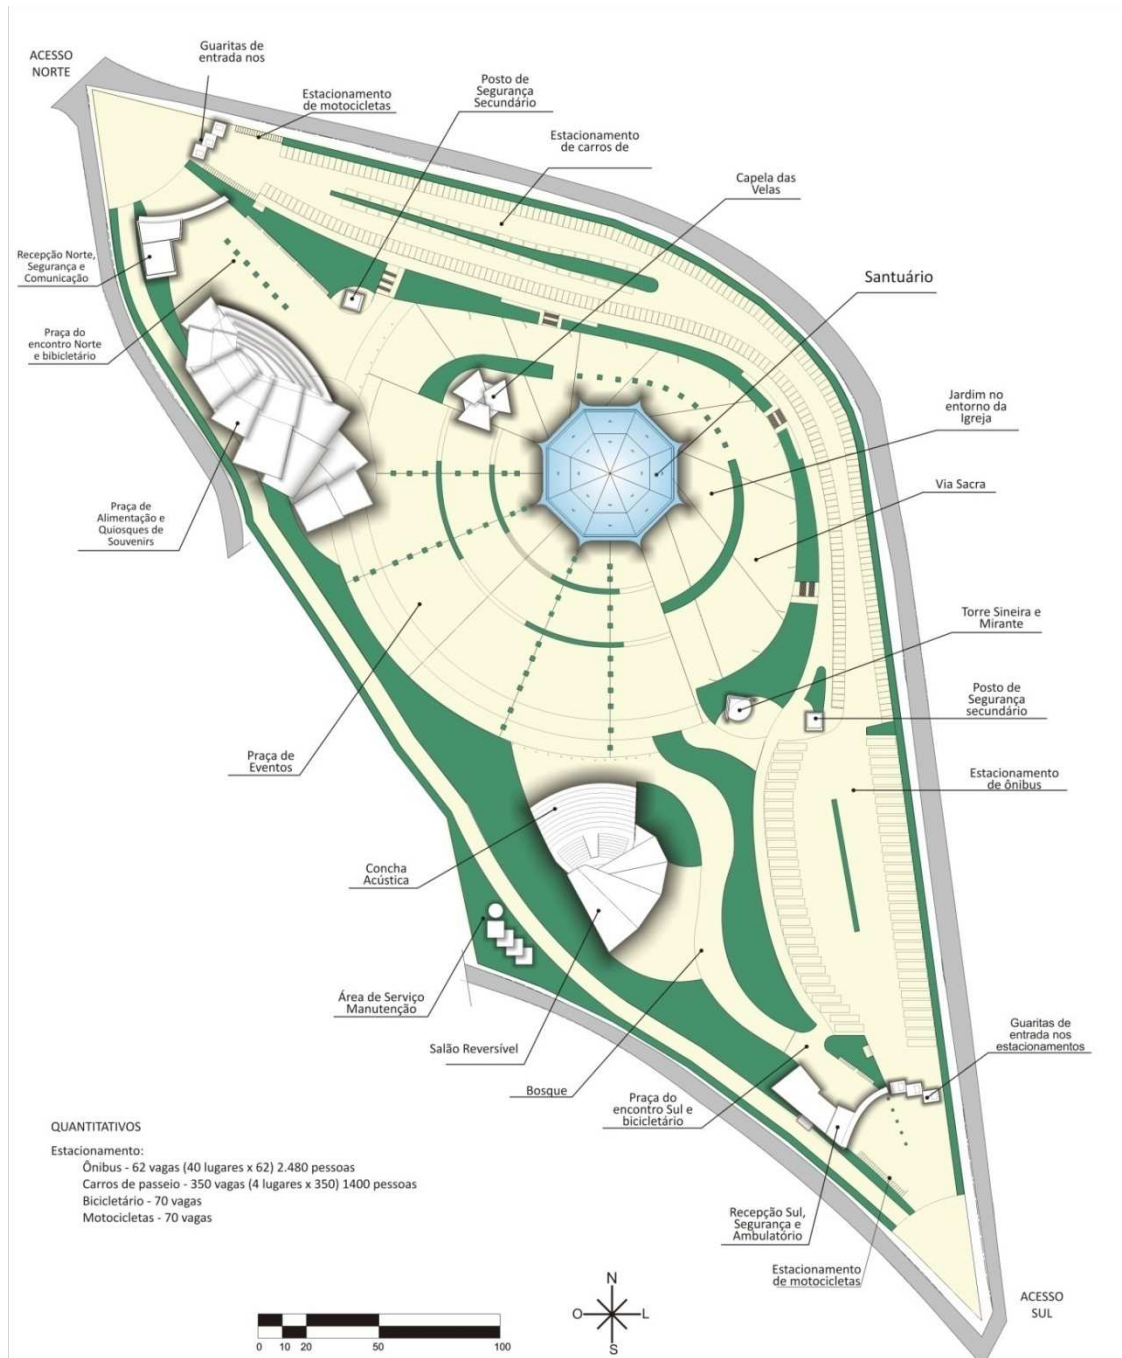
Planta de Implantação. Partido arquitetônico das áreas externas do novo santuário.
